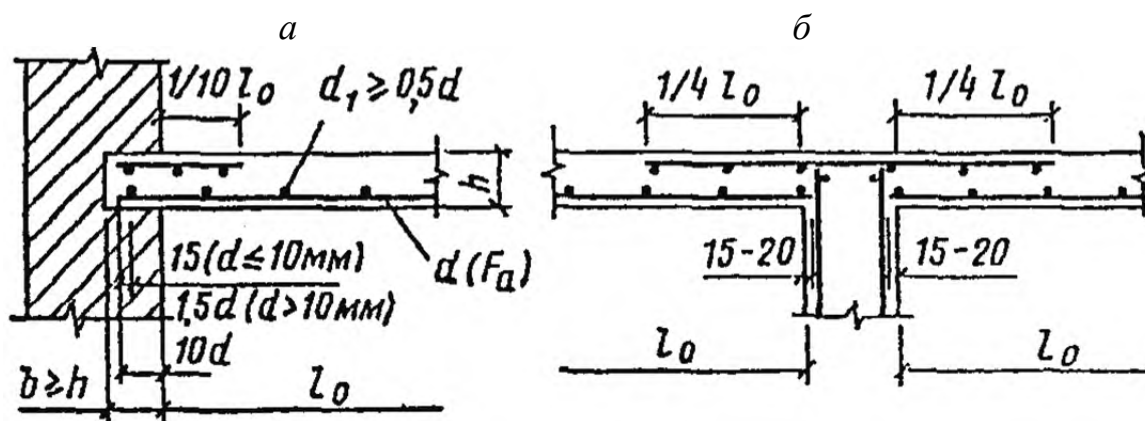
Монолитные неразрезные перекрытия, защемленные в наружных (а) и внутренних (б) стенах при контактных сопряжениях
